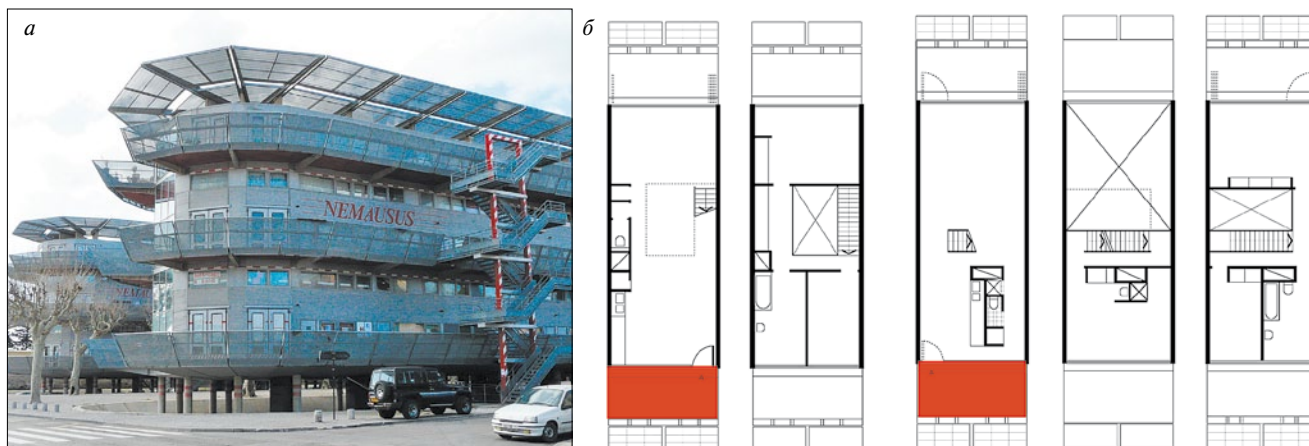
Жилой комплекс. Немаузус I и II. Арх. Жан Нувель и Жан-Марк Ибо и др. Франция, Ним (1985–1988 гг.): а – фасад; б – фрагменты планов
